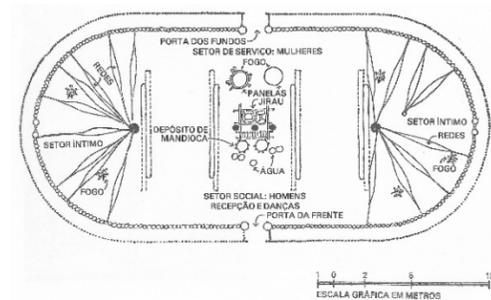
Casa Yawalapiti: planta baixa com equipamento (casa 4 na planta geral da aldeia).
